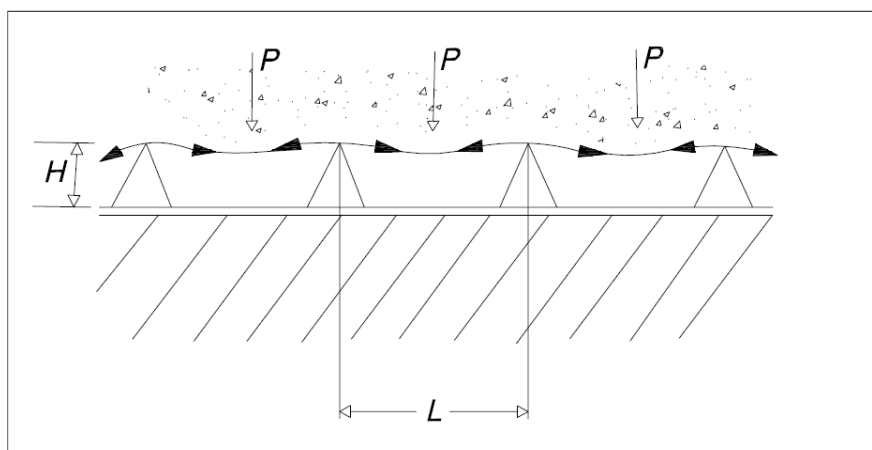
Diminuzione dell'area della sezione trasversale del geocomposito drenante a contatto con il terreno
